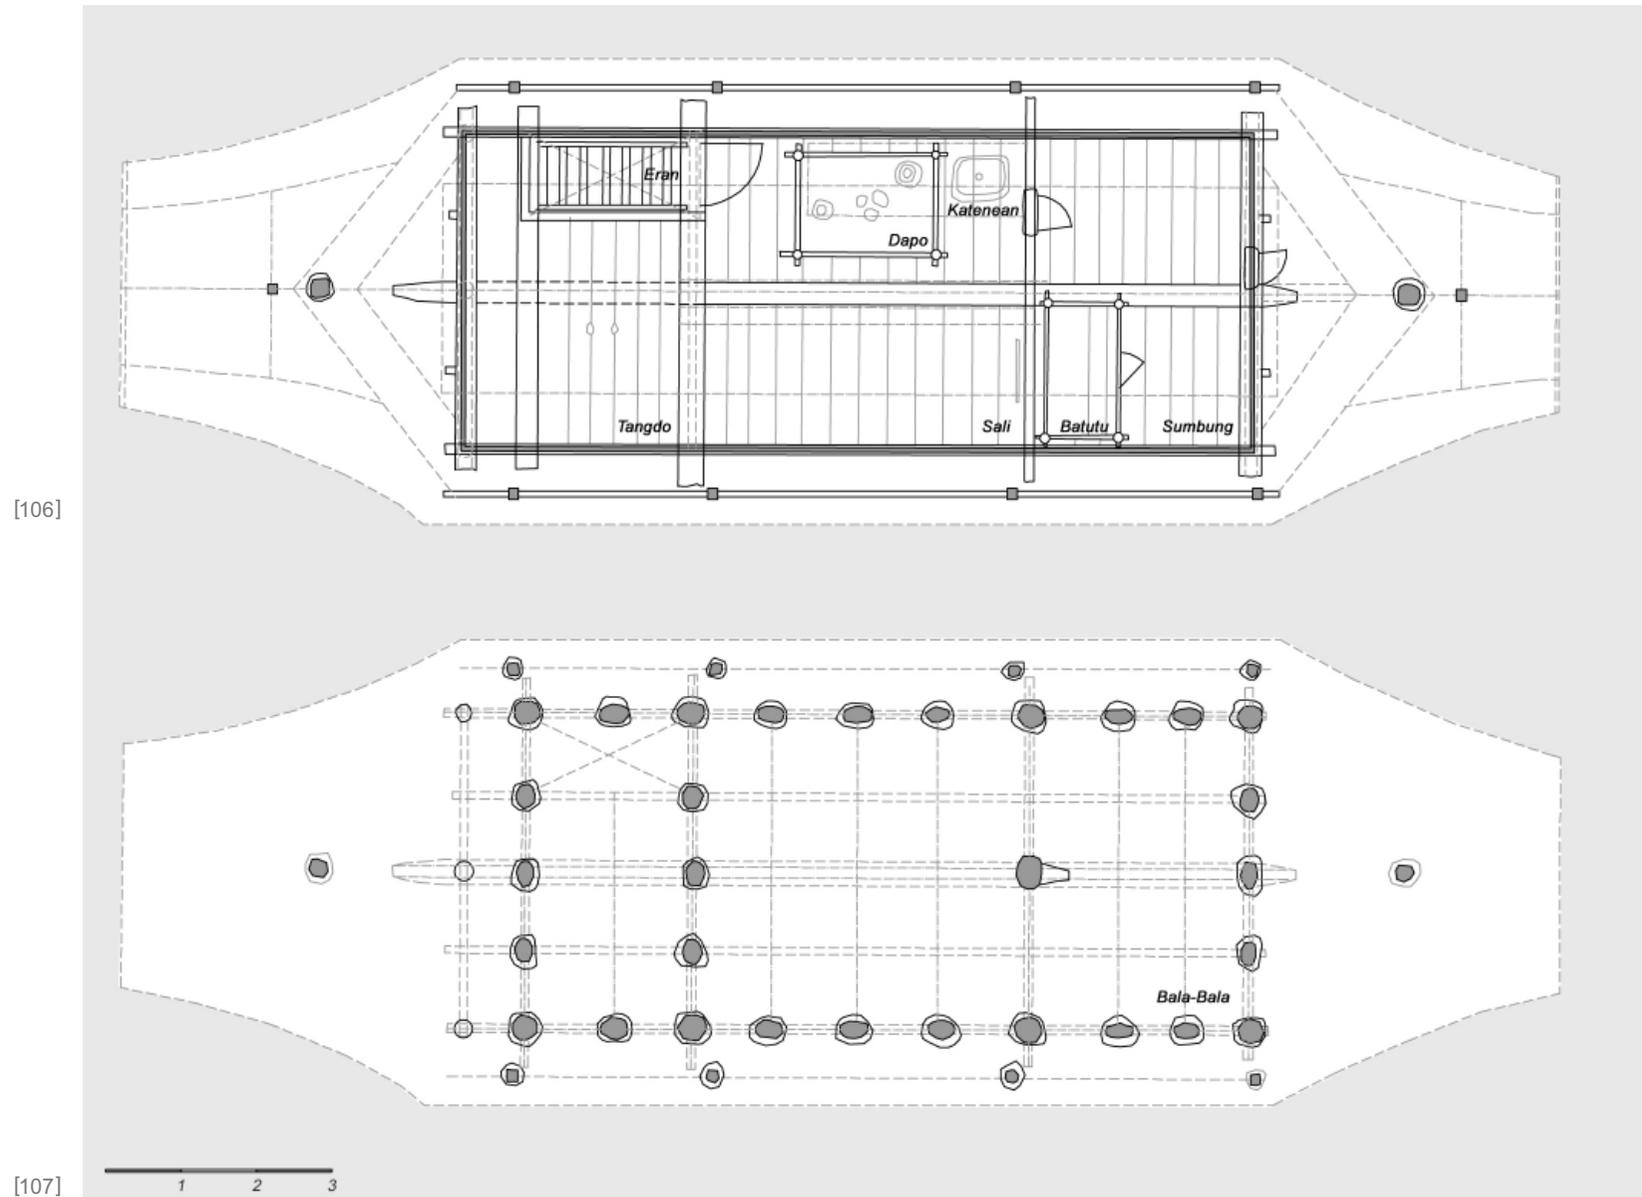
Grundriss Wohnebene. Abb.107: Grundriss Bala.
